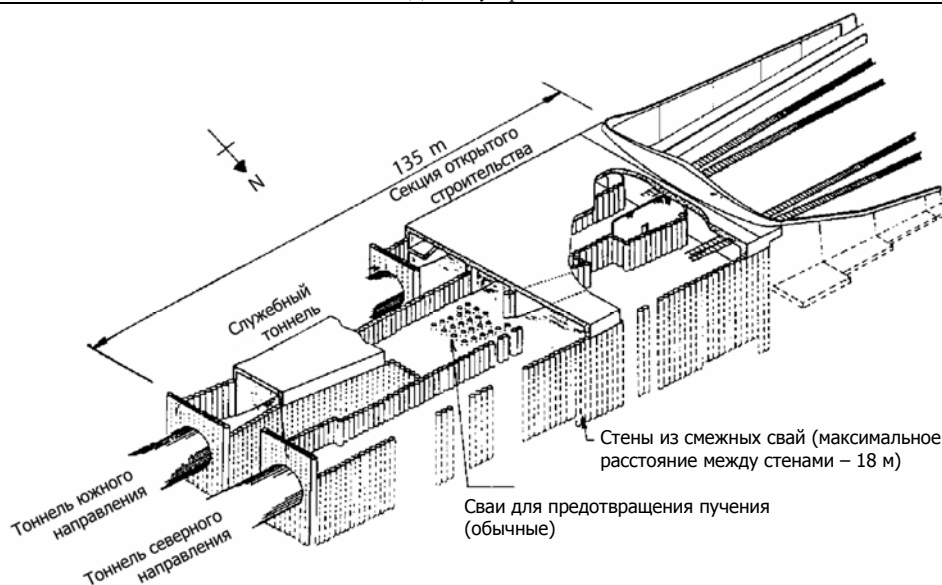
Открытый способ строительства на площадке западный Касл Хилл
